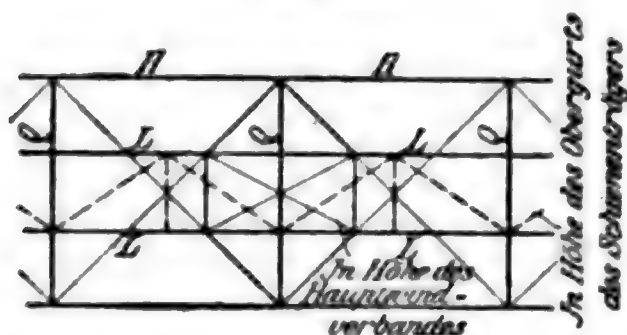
Bremsverband an jedem Brückenende. Damit die Spannkkräfte des Hauptträgergurtes
